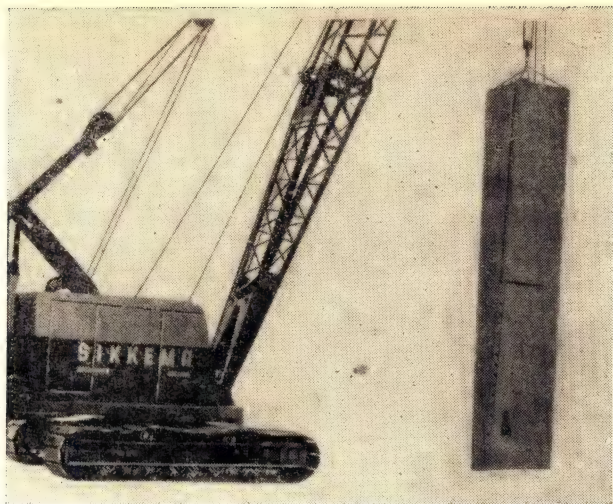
Звукоизолирующий чехол копра для забивки свай
